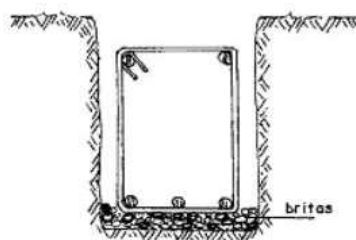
Fundo de viga baldrame, lastro de pedra britada.
